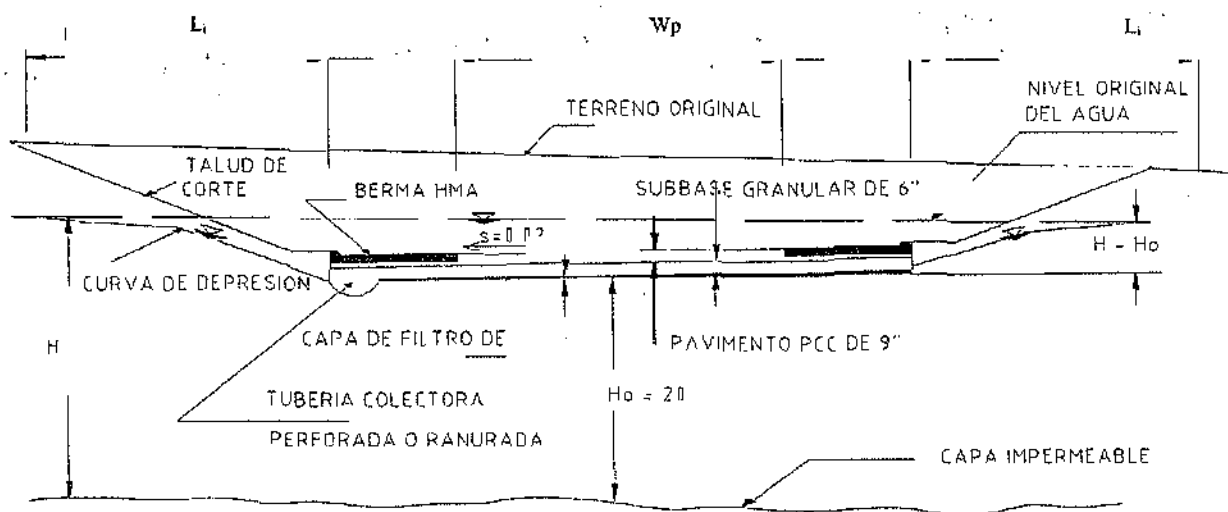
Sección transversal de subdrenaje de pavimentos rígidos (1pie= 0.305m, 1pulg.= 25.4mm)
